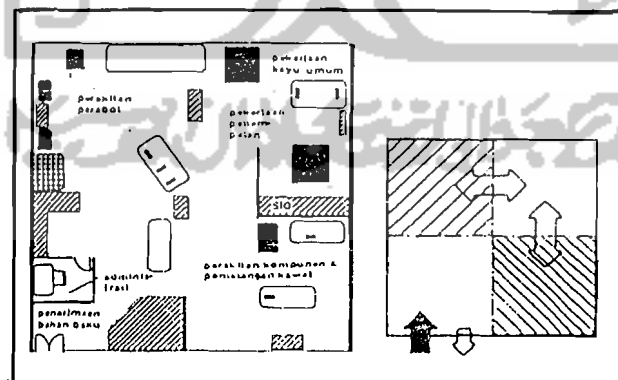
Modul Ruang Kelas sebagai Ruang Praktek (Studio)
